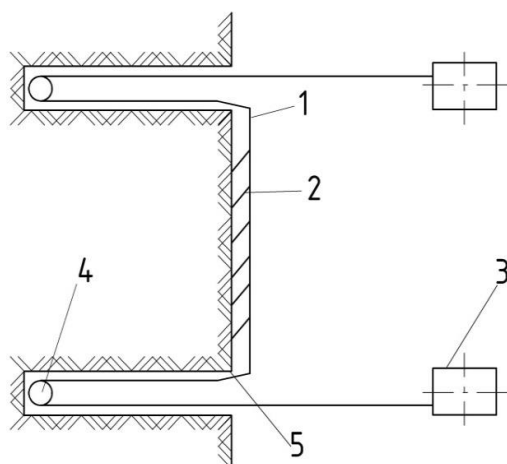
Рыхление с механической подрезкой канатным стругом:
